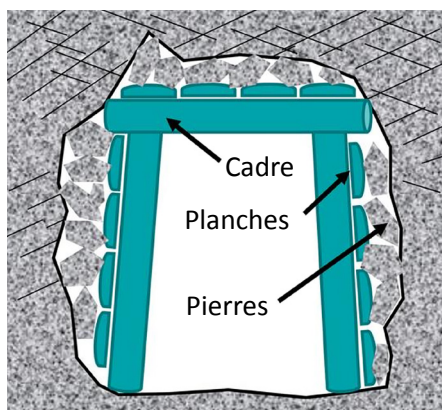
Principe du cadre de soutènement avec la protection latérale par des planches.
